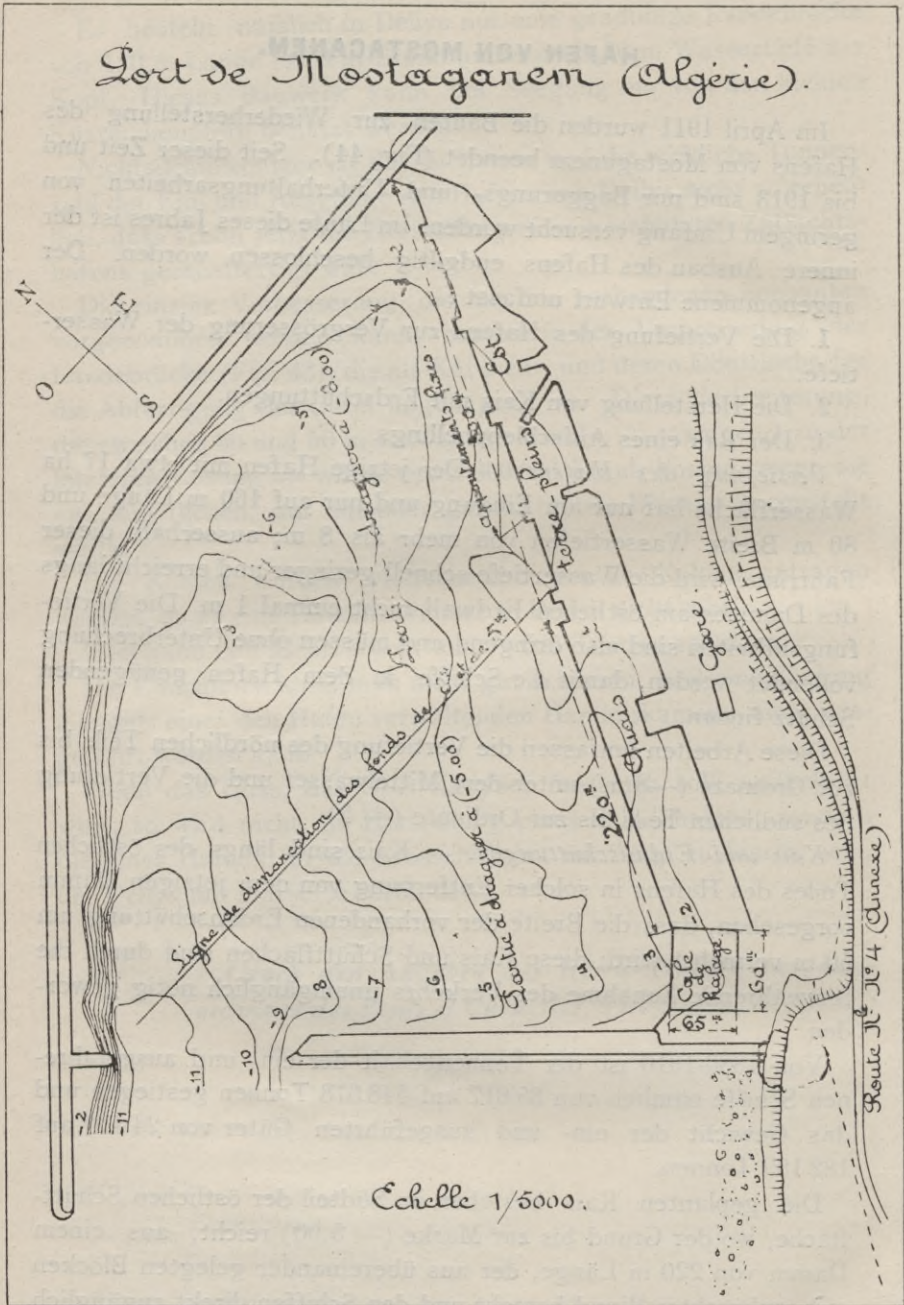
Plan des Hafens von Mostaganem mit Angabe der angeordneten Bauausführungen.
